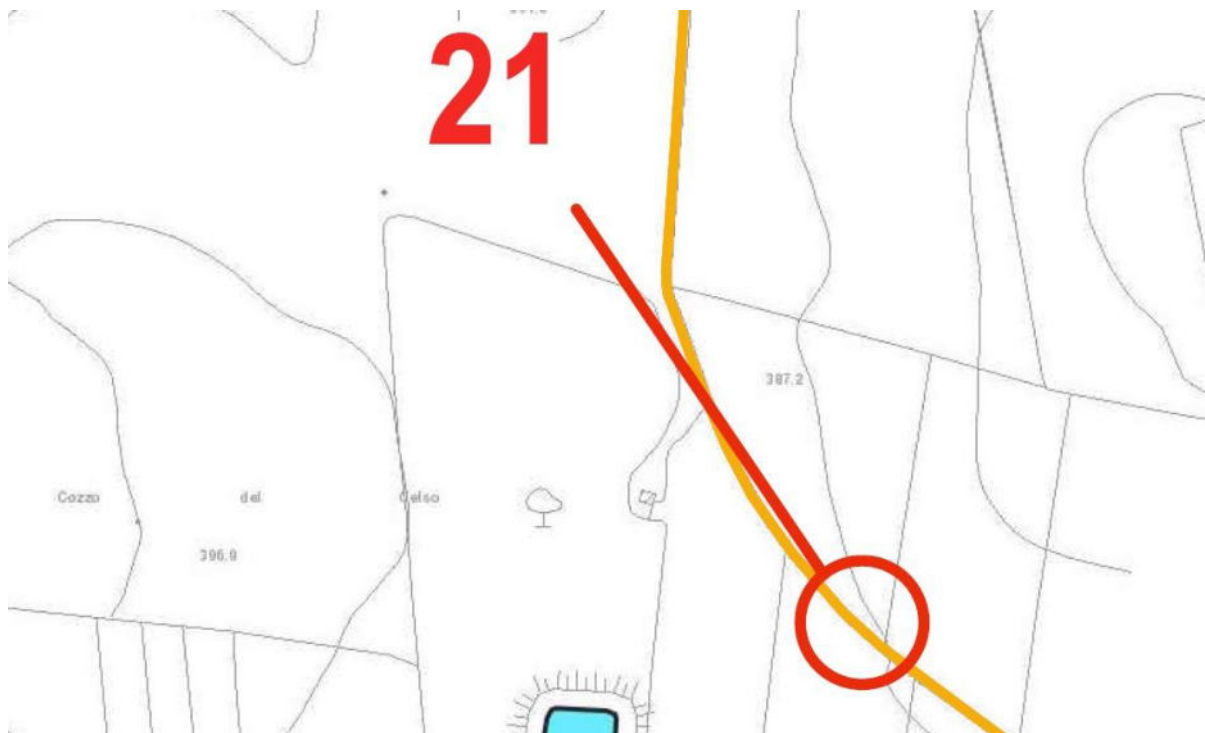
Planimetria CTR con individuazione attraversamento in cls
